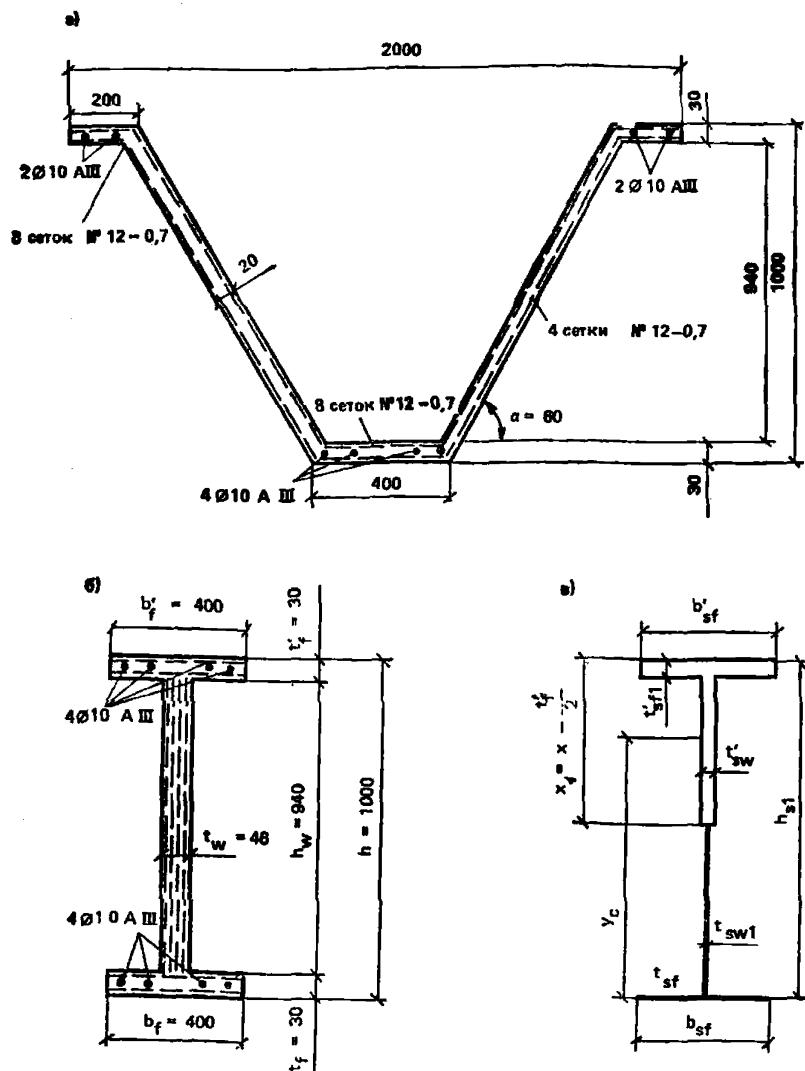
Армокементный складчатый внерадиально сжатый элемент покрытия
